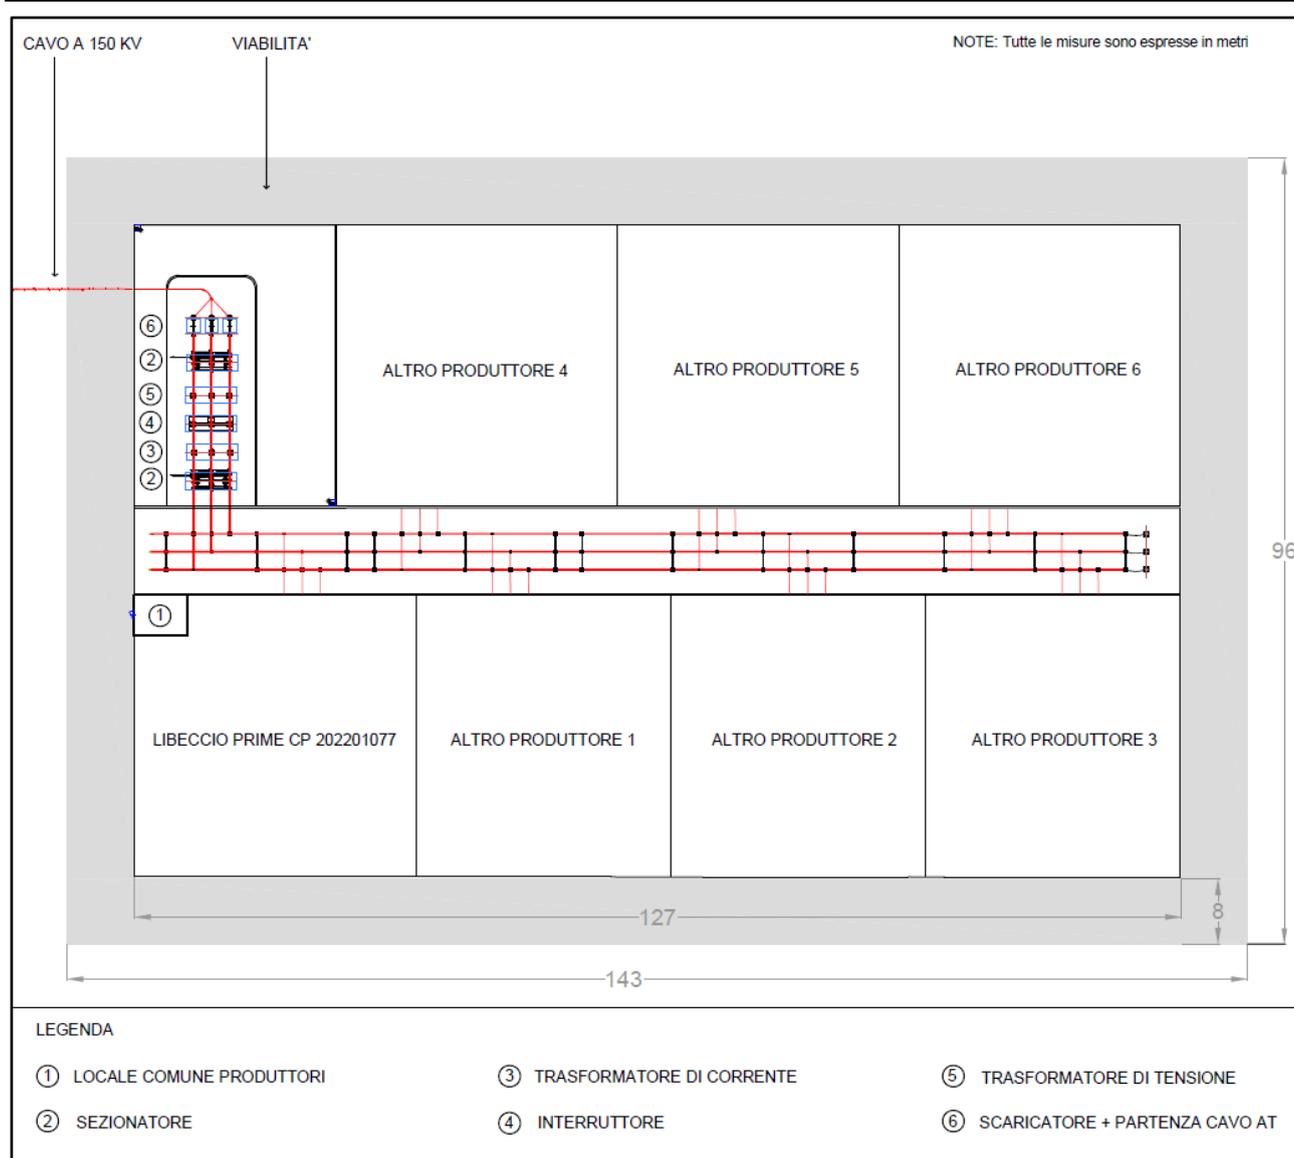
Planimetria elettromeccanica della sottostazione elettrica condivisa
